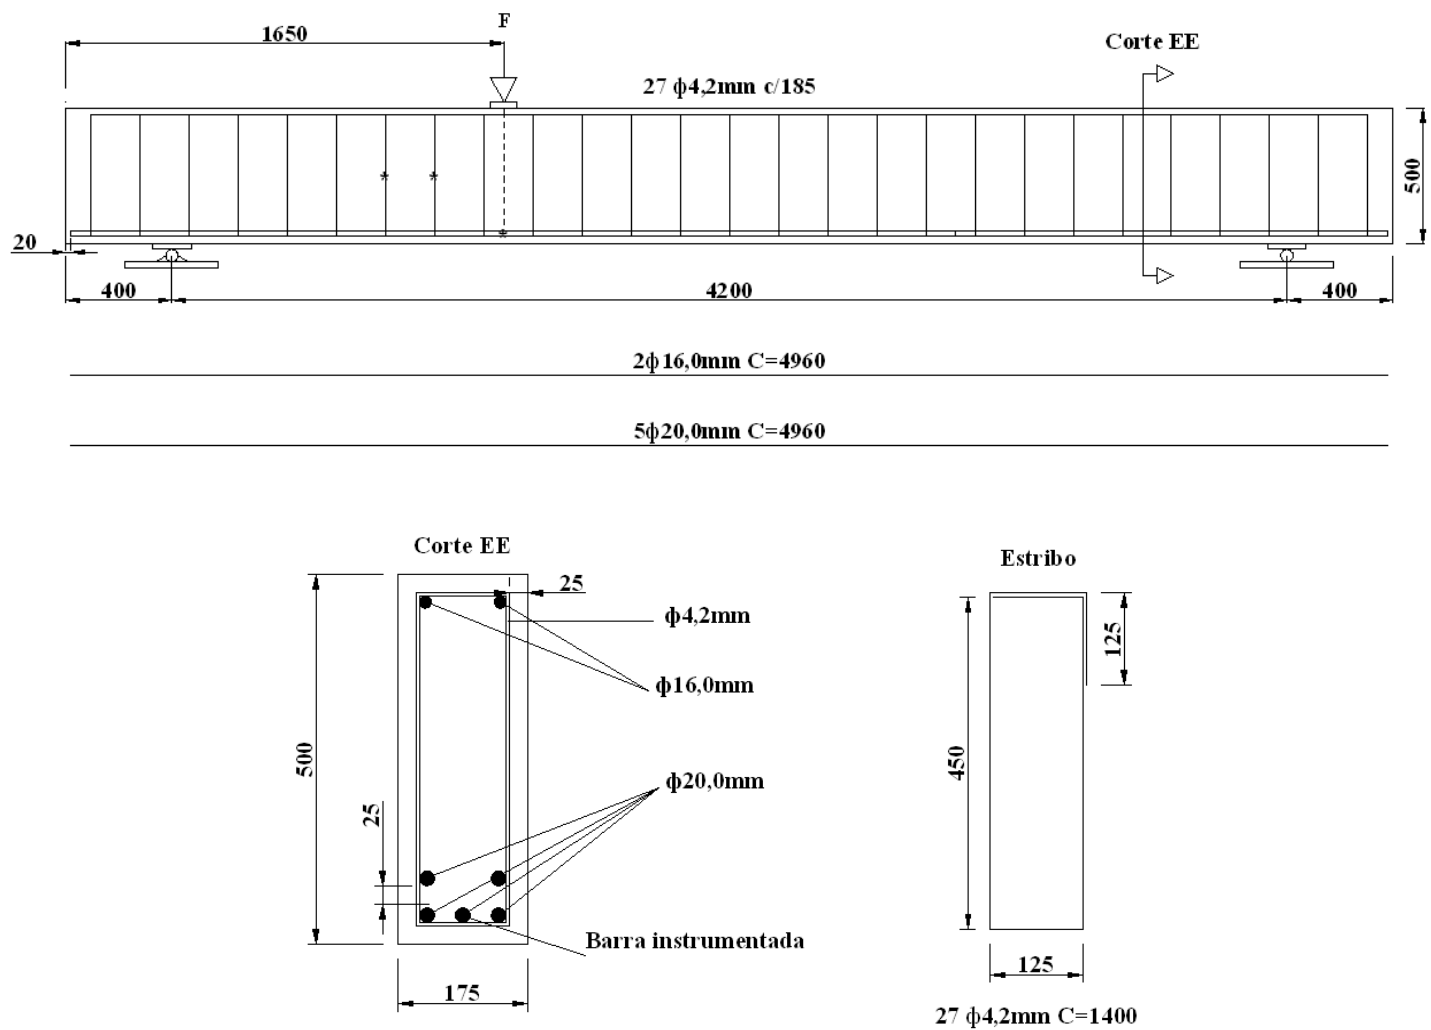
Armaduras e posicionamento dos extensômetros (\*) da viga V5 (dimensões em mm).
